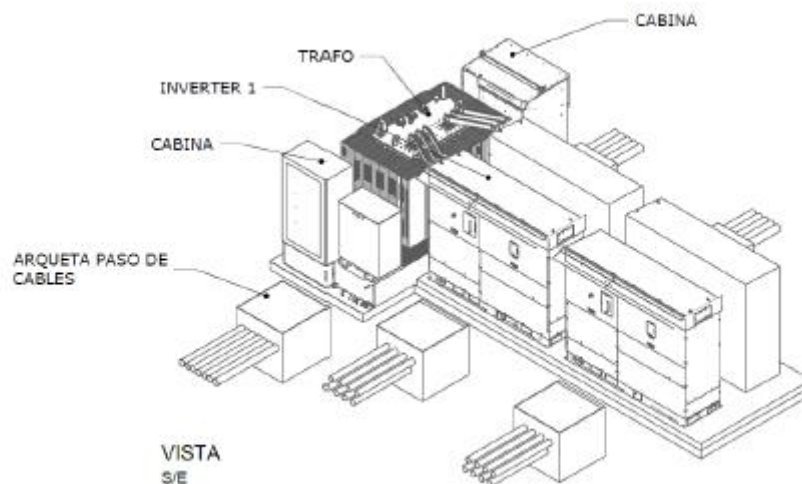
a. Power Block proyecto tramitado (hasta 4 inversores). Fuente: Reformado de proyecto de planta solar fotovoltaica "FV Salinas II 49,5 MWp".
